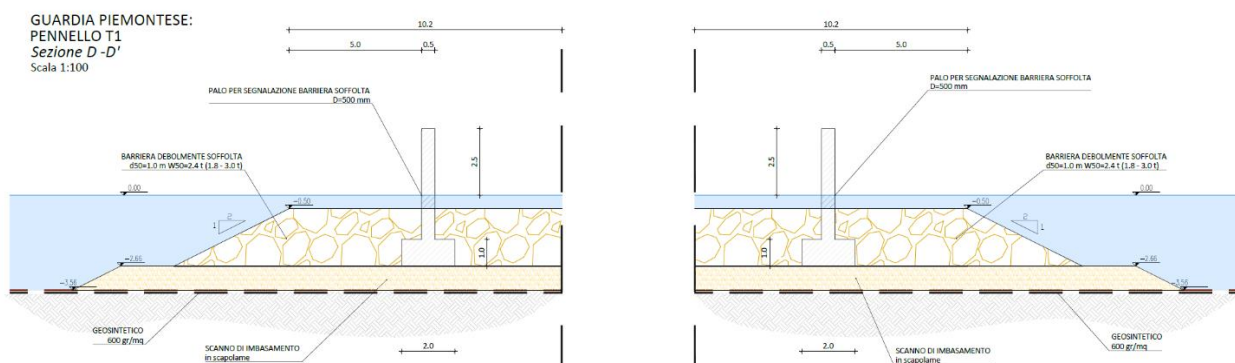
Stralcio trasversale barriera a cresta bassa
